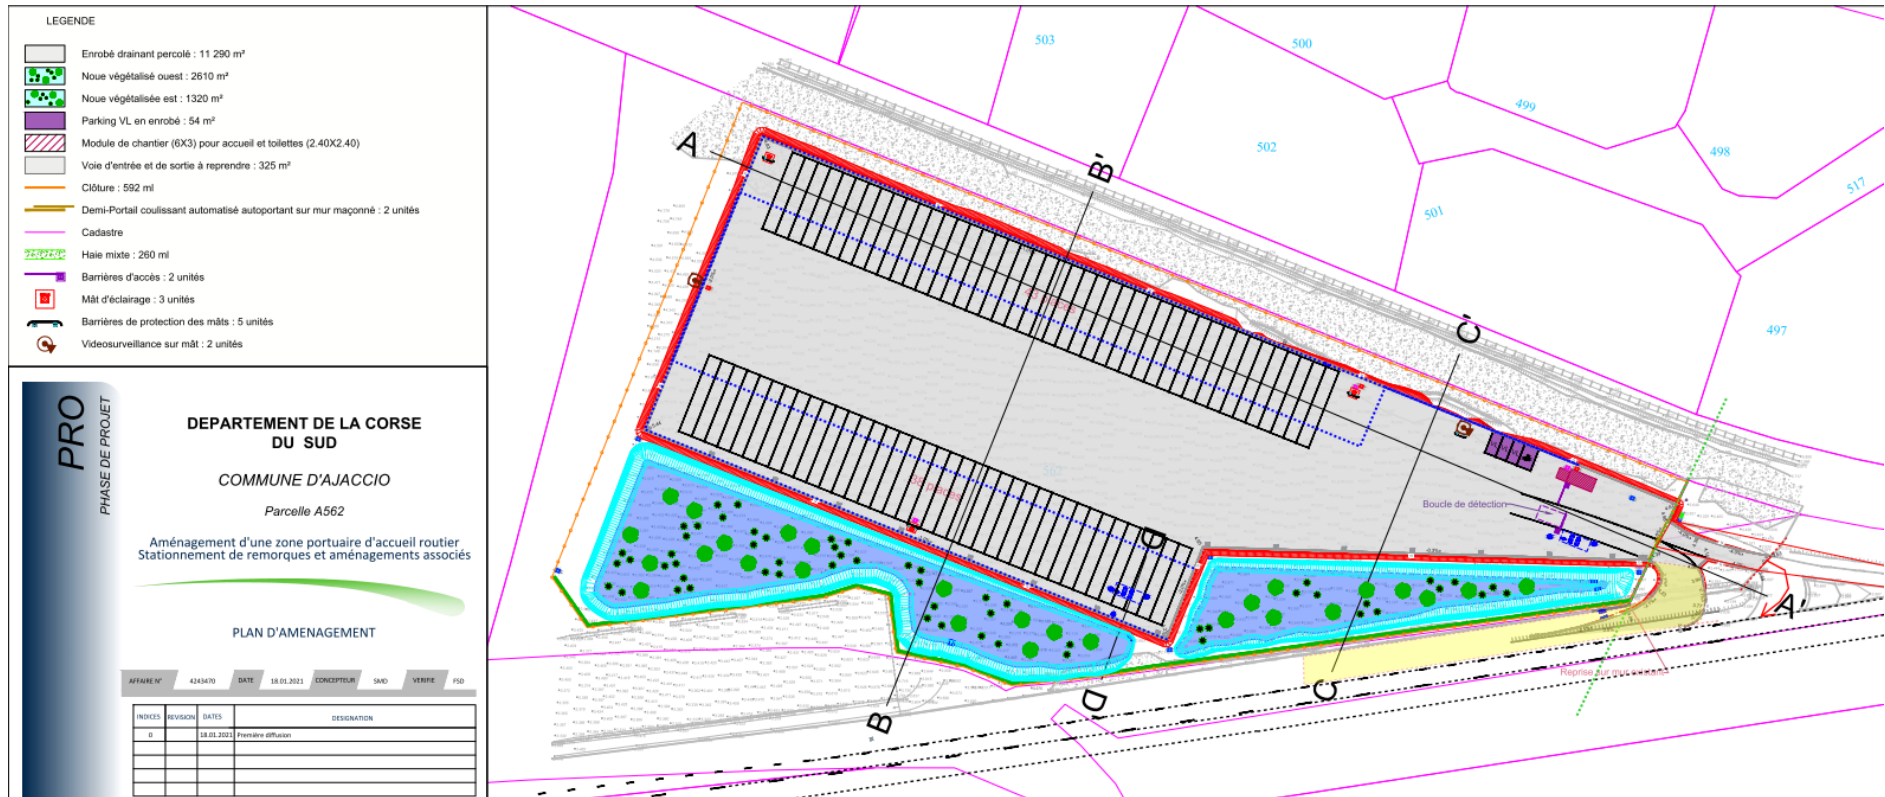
Plan d'aménagement du projet (VARIANTE N°3)
